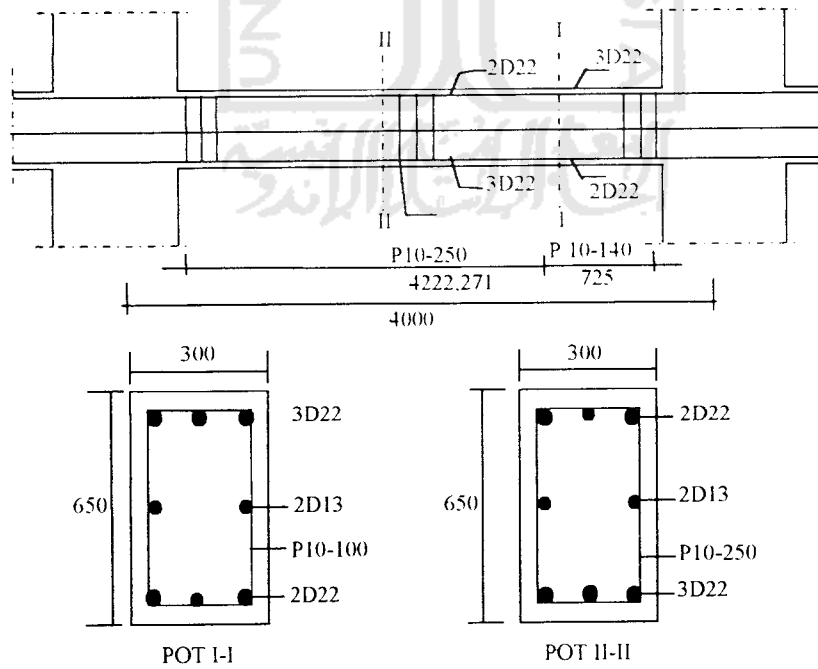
Balok Portal E Bentang 4 m Lantai 10
